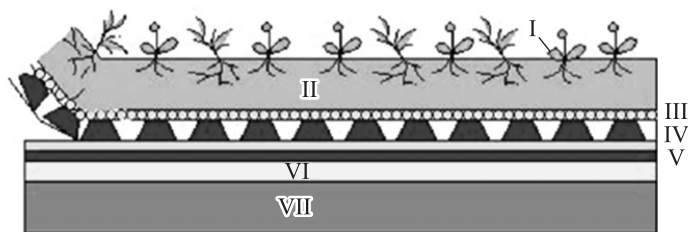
Сплошные встраиваемые кровельные конструкции с озеленением в виде дополнительных покрытий
